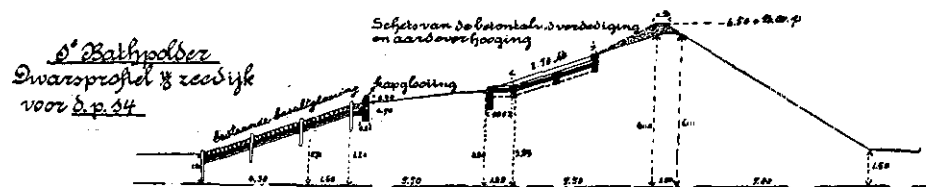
Buitentalud, bovenbeloop, met betonglooiing verdedigd om aangebrachte grondverhoging te beschermen tegen ondermijning door uitspoeling.
